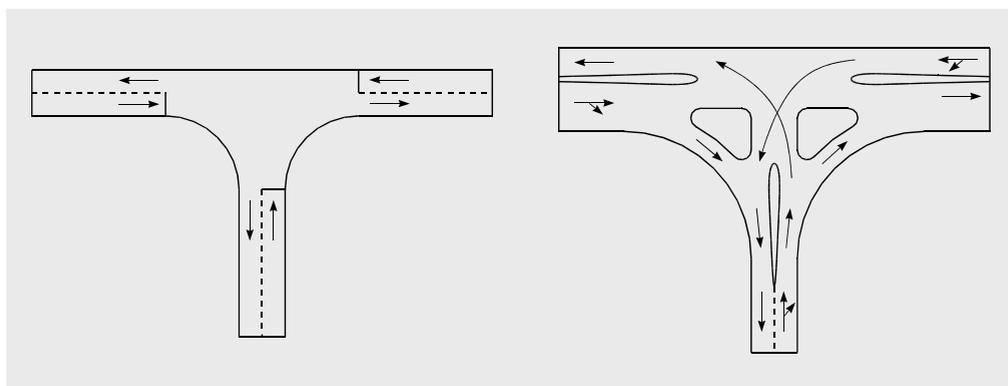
Intersecciones sin canalizar y canalizada
